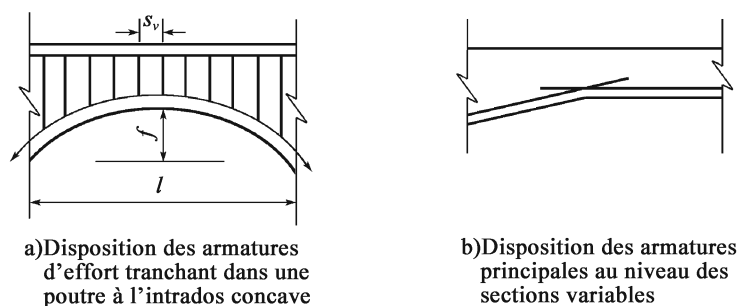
Dispositions des cadres, près de la surface concave et des armatures qui se croisent.
